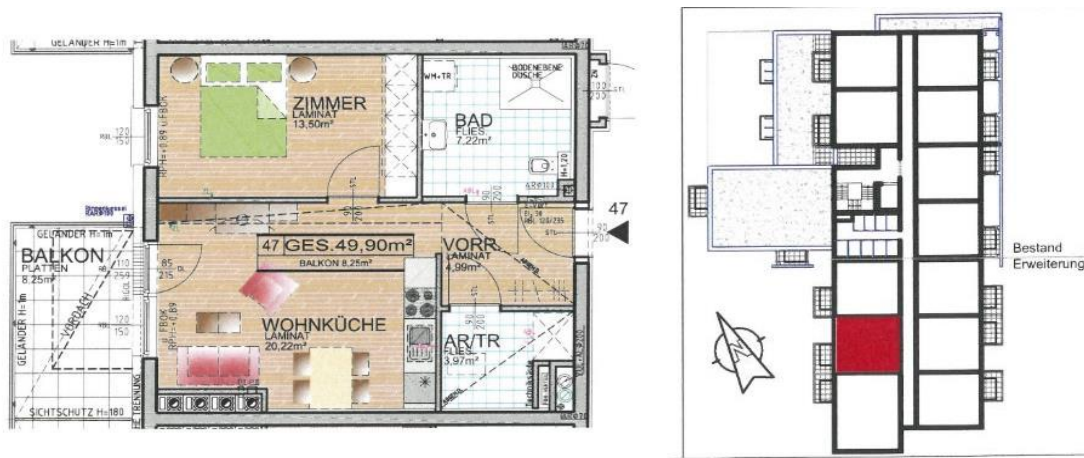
Plan Wohnung I und Übersichtsplan Erdgeschoß (Bauabschnitt 1)
